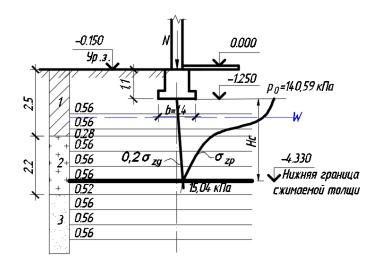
Расчетная схема для определения осадки столбчатого фундамента
